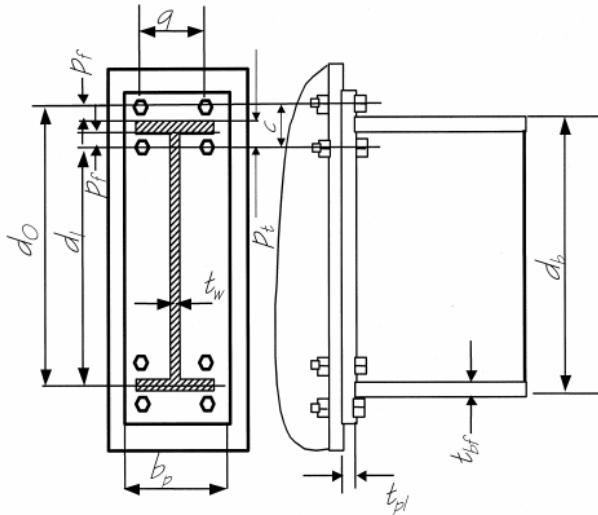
c. Assemblage par platines d'à bout non raidies soudées à la poutre et boulonnées à l'aile du poteau par 4 rangées de boulons.
